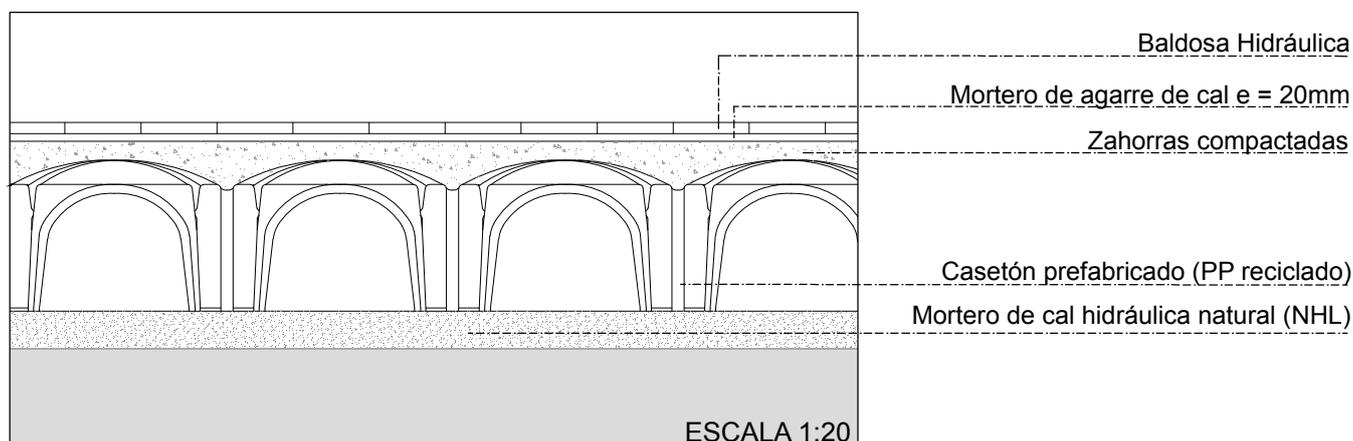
Detalle constructivo: forjado sanitario. 2018. Fuente propia.
